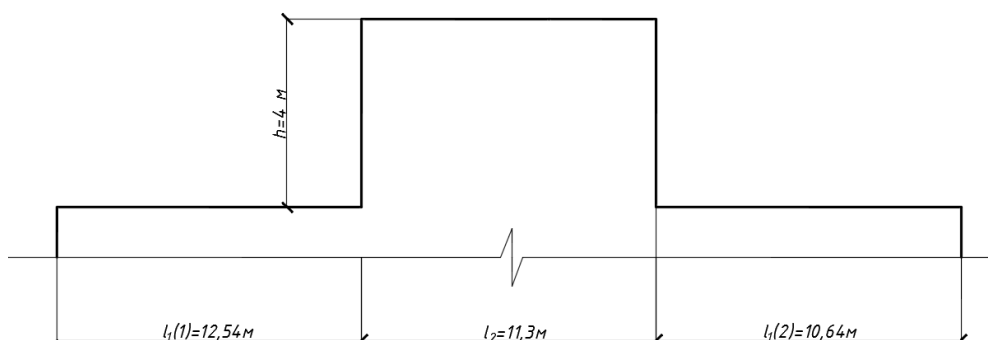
К расчету снеговой нагрузки на покрытие в зоне выхода на кровлю
